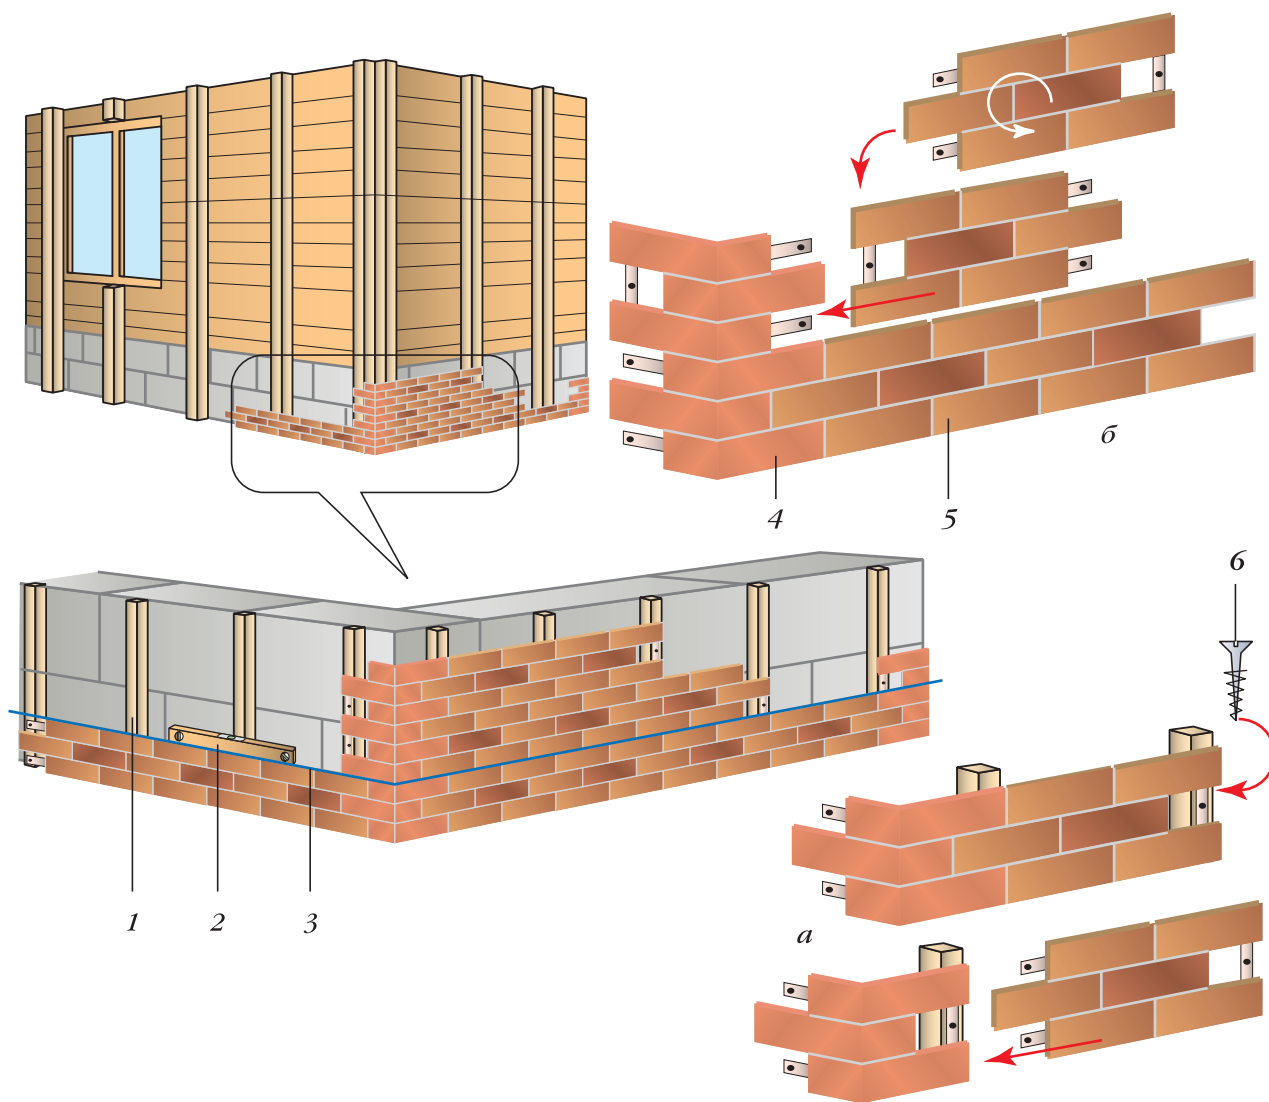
Общая схема монтажа облицовочных панелей: а — монтаж первого ряда начинают от угла; б — монтаж второго ряда начинают с перевернутой плиты облицовки; 1 — обрешетка; 2 — строительный уровень; 3 — шнурка; 4 — угловая панель; 5 — рядовая панель; 6 — саморез
